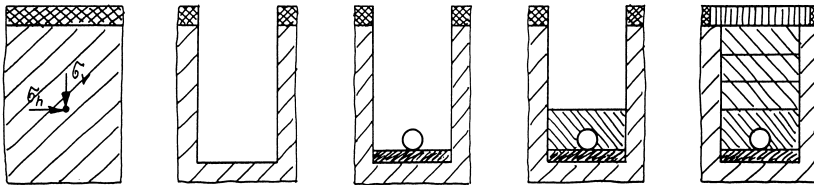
Verlegung und Einbau erdverlegter Rohrleitungen in offener Bauweise
